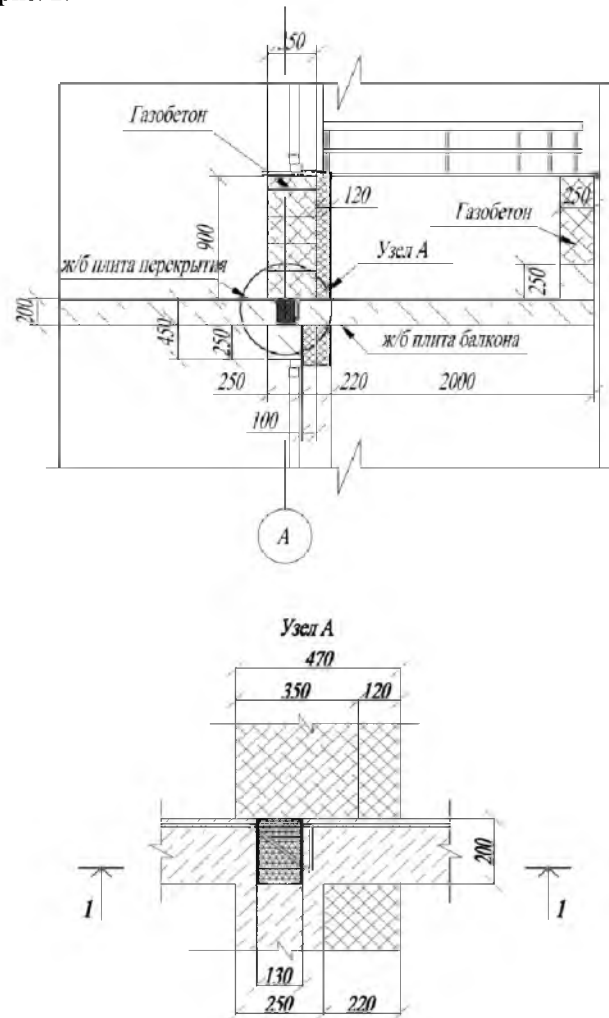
Конструктивный узел «балконная плита – ограждающая конструкция – плита перекрытия» с устройством армированного теплоизоляционного элемента: узел А /
